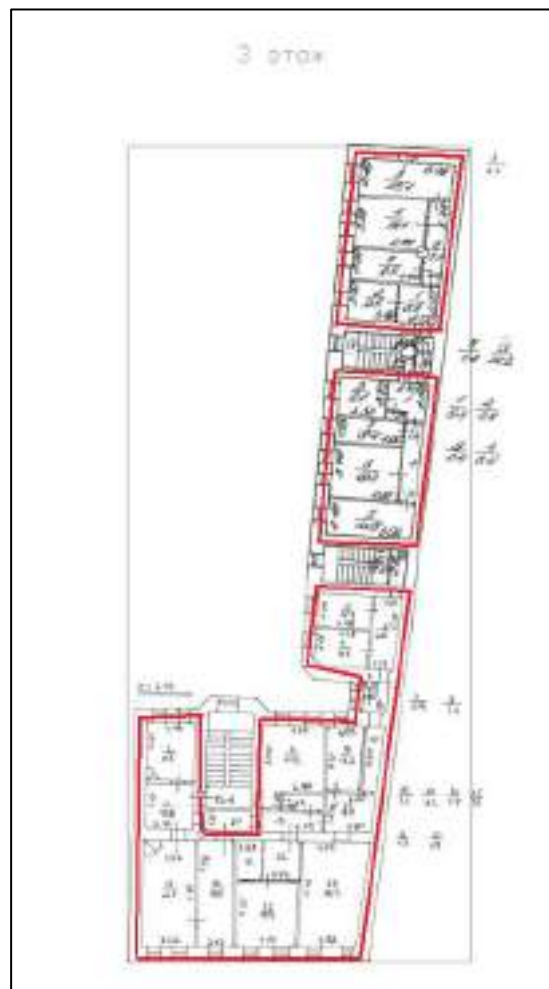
План оцениваемых помещений 12 - Н - 14-Н Синопская набережная, 24 А
